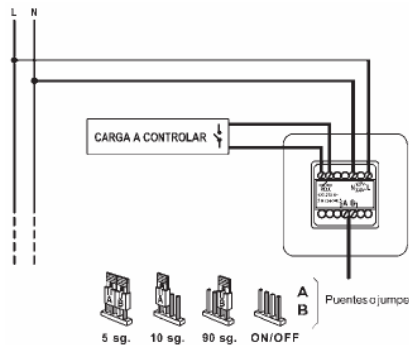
Esquema de conexiones del teclado codificado para cargas y dispositivos con entrada libre de potencial.
